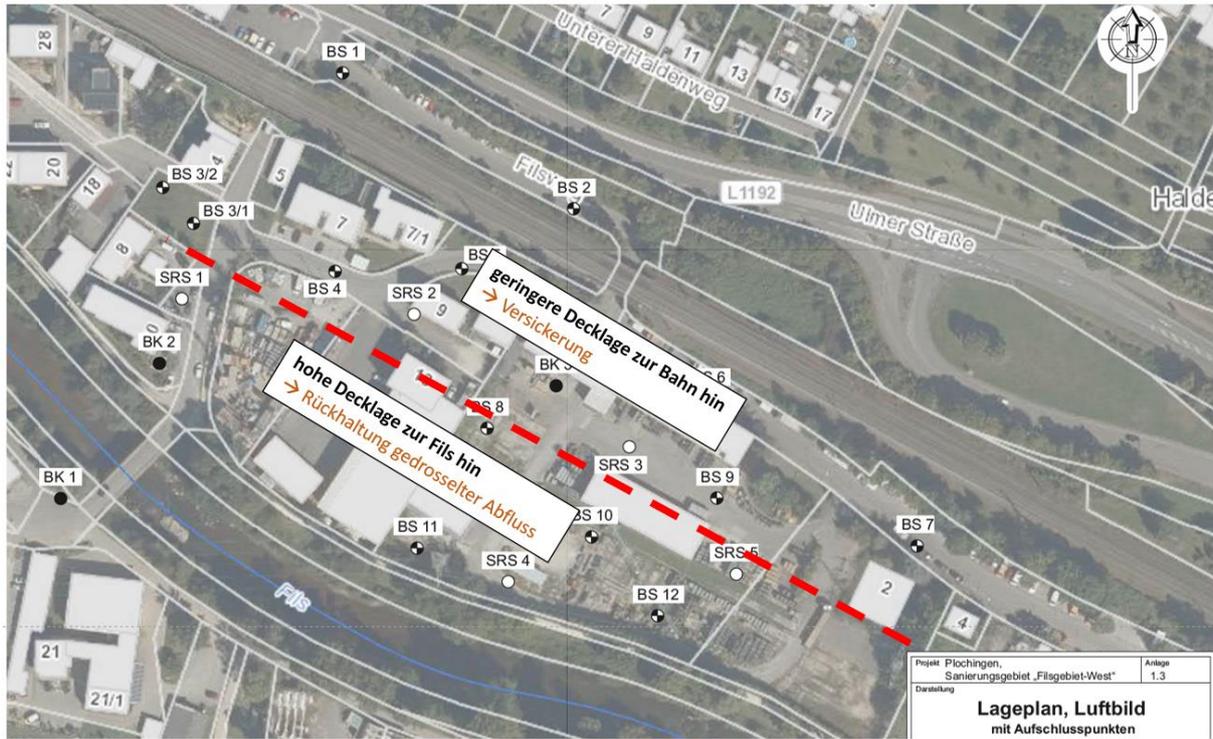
Schlussfolgerung für die eine potenzielle Versickerung, Planstatt Senner (2023)
